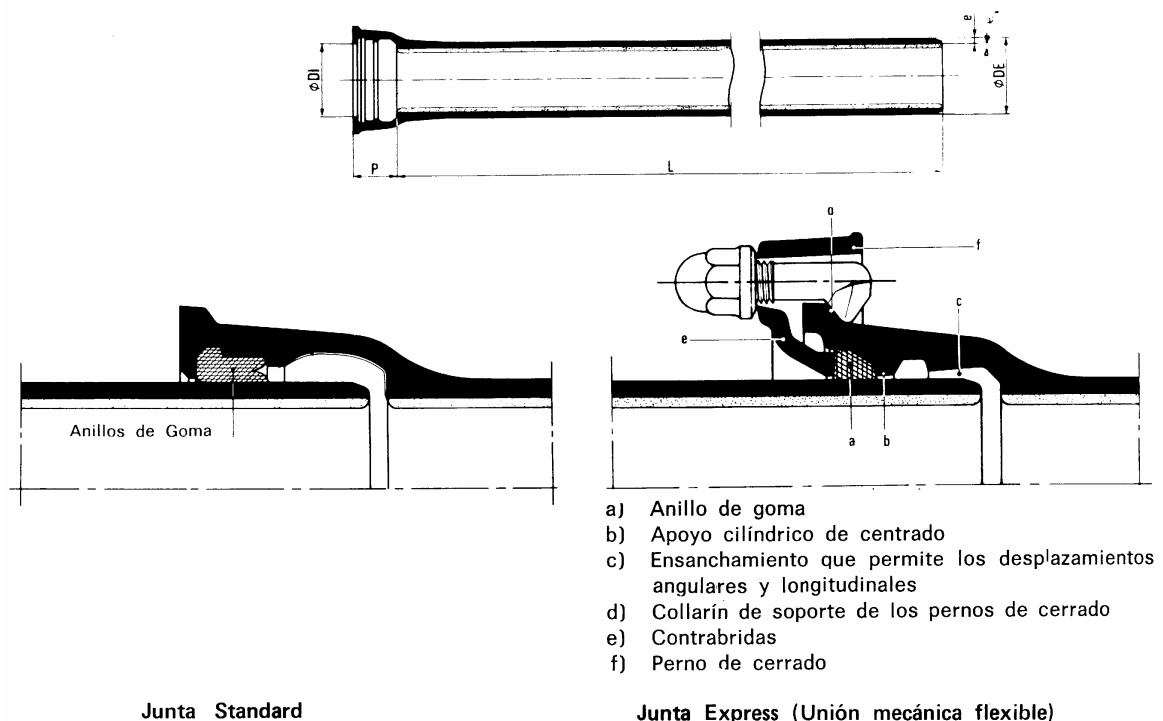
Unión standard y mecánica flexible en tuberías.
